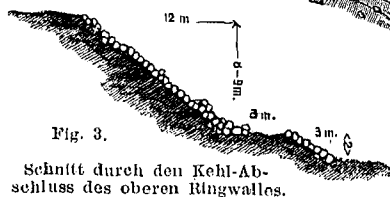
Schnitt durch den Kehl-Abschluss des oberen Ringwall.
